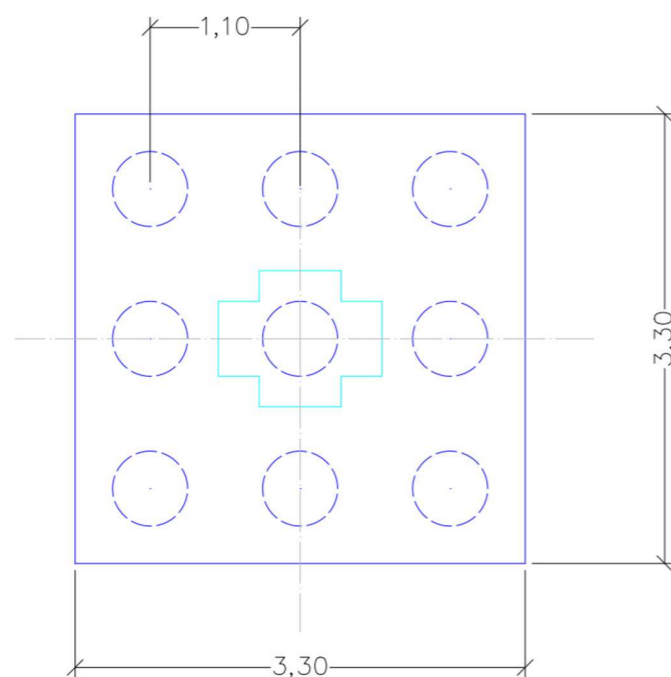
Dimensiones y disposición de los pilotes de la cimentación de la pila P8 en planta, en metros.
